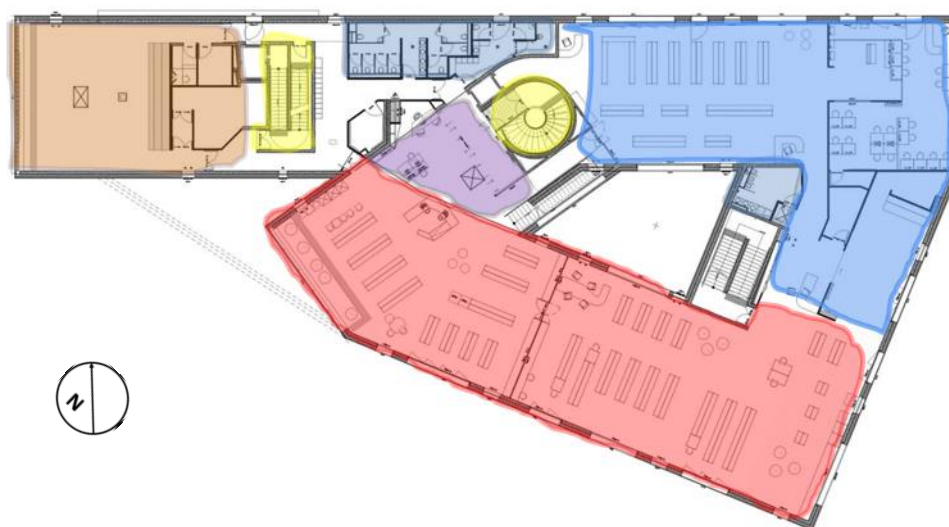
Plan du 1<sup>er</sup> étage.
